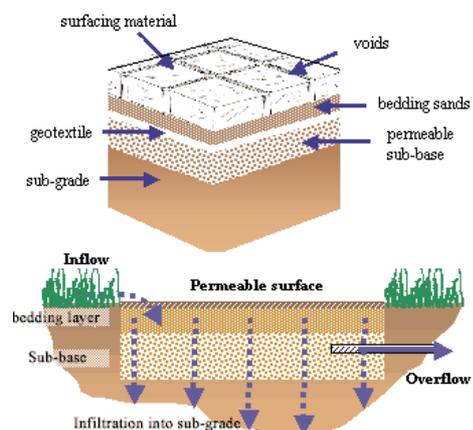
< Pavimentazioni drenanti in Inghilterra ->
